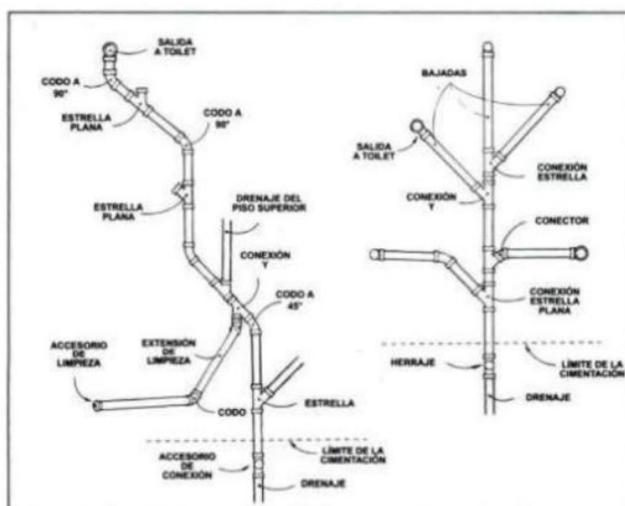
Plano en Planta de un Sistema de Desagüe en un Baño
